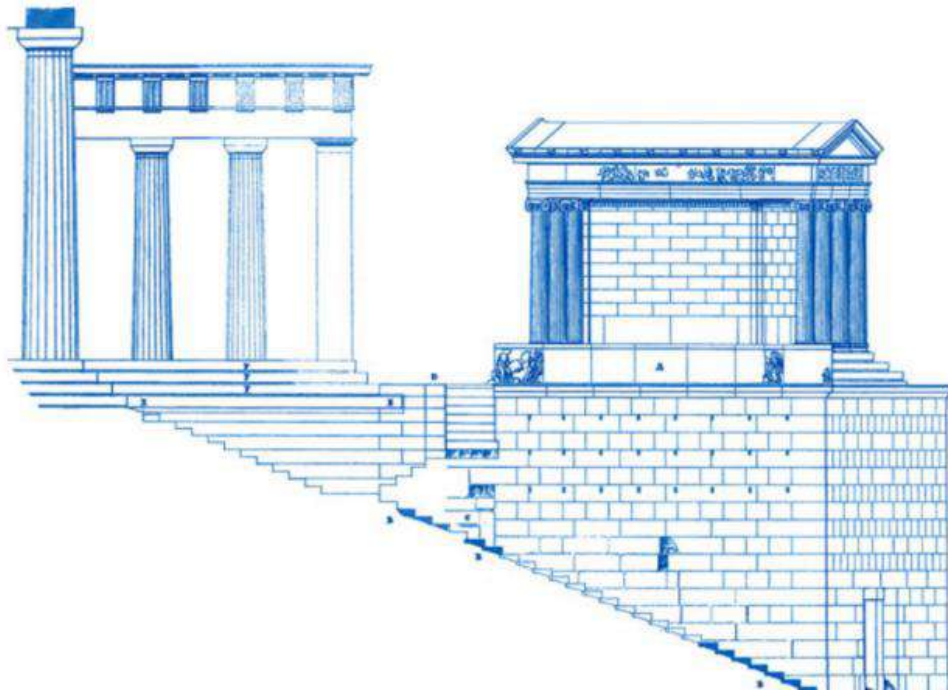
Dibujo del arquitecto Elevación Sur Gustav Eduard Schaubert. Ludwig Ross, Schaubert y Hansen.
